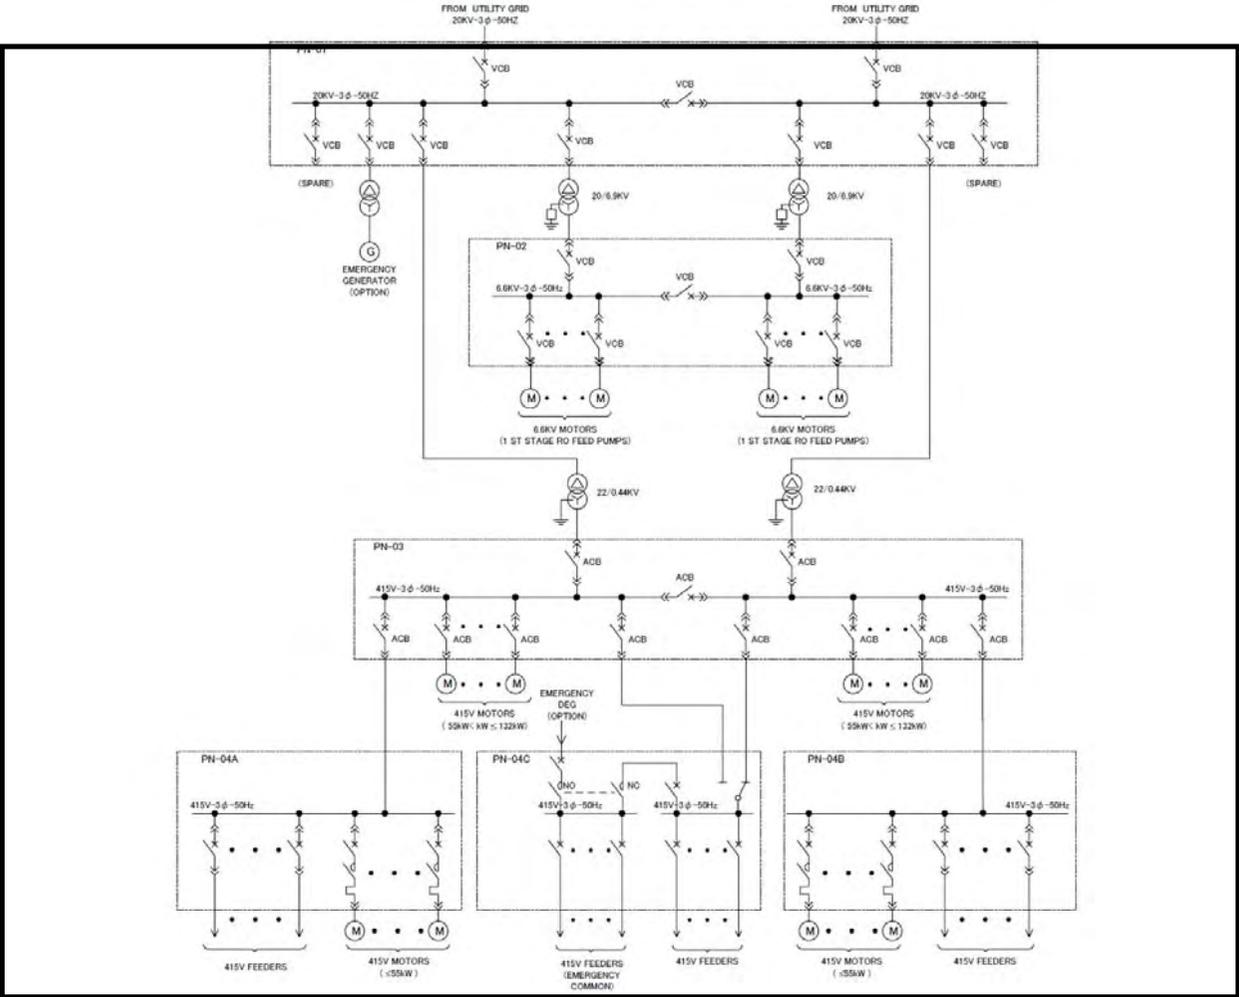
Plano esquemático das instalações de dessalinização de água do mar em Palmarejo (2/2)
